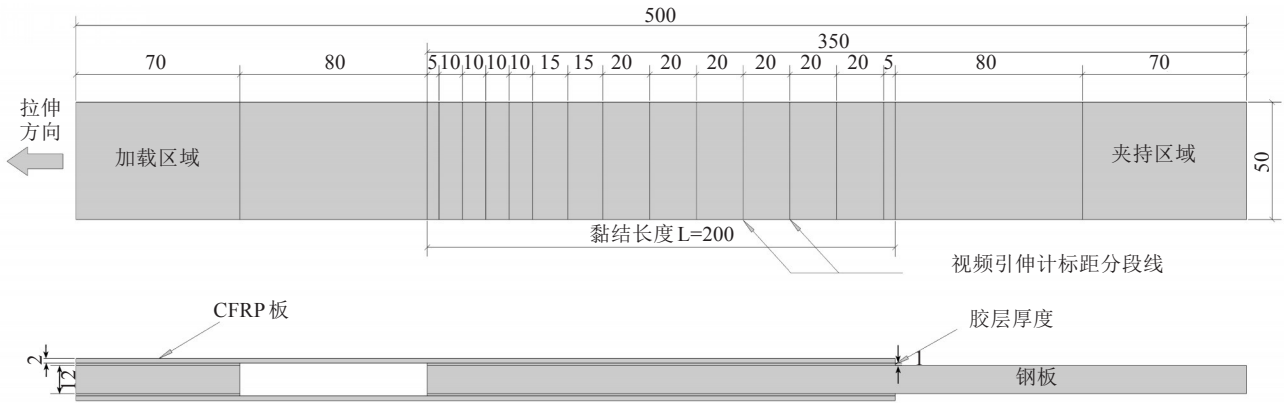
CFRP-钢双搭接试件尺寸 (单位: mm)
